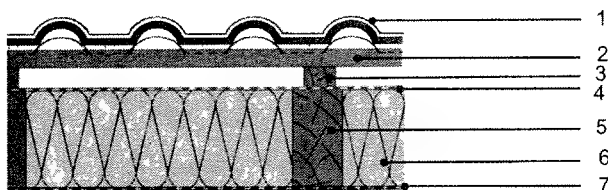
Схема кровельного «пирога» с применением подкровельной пленки Tyvek:
